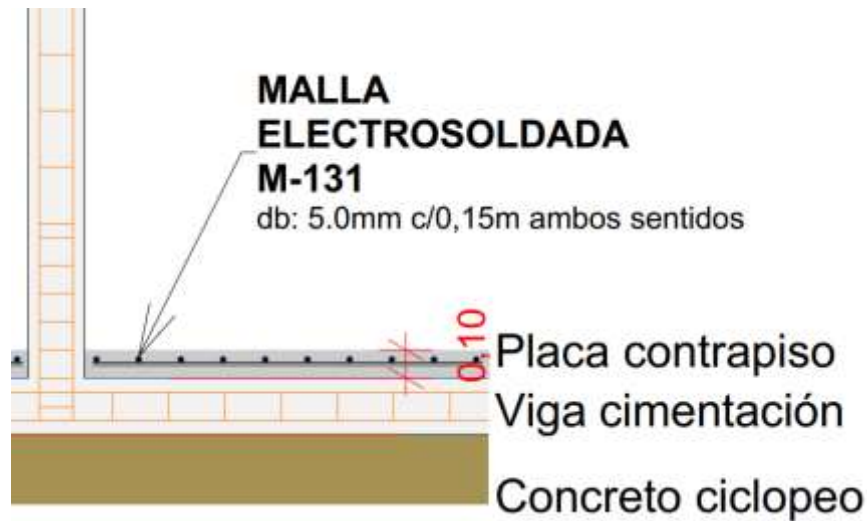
SECCION DETALLE DE PLACA DE CONTRAPISO. Fuente: AutoCAD, elaboración propia.
